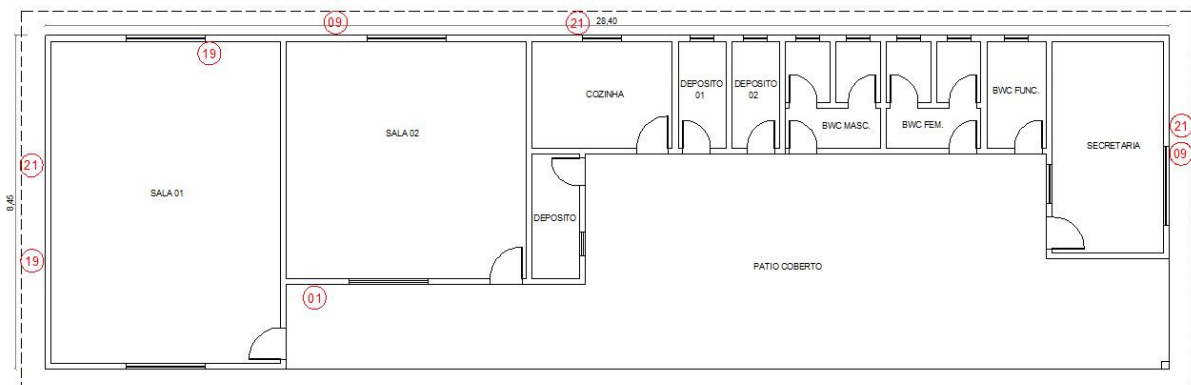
Planta Baixa creche Pequeno Mundo – Cristo Rei
